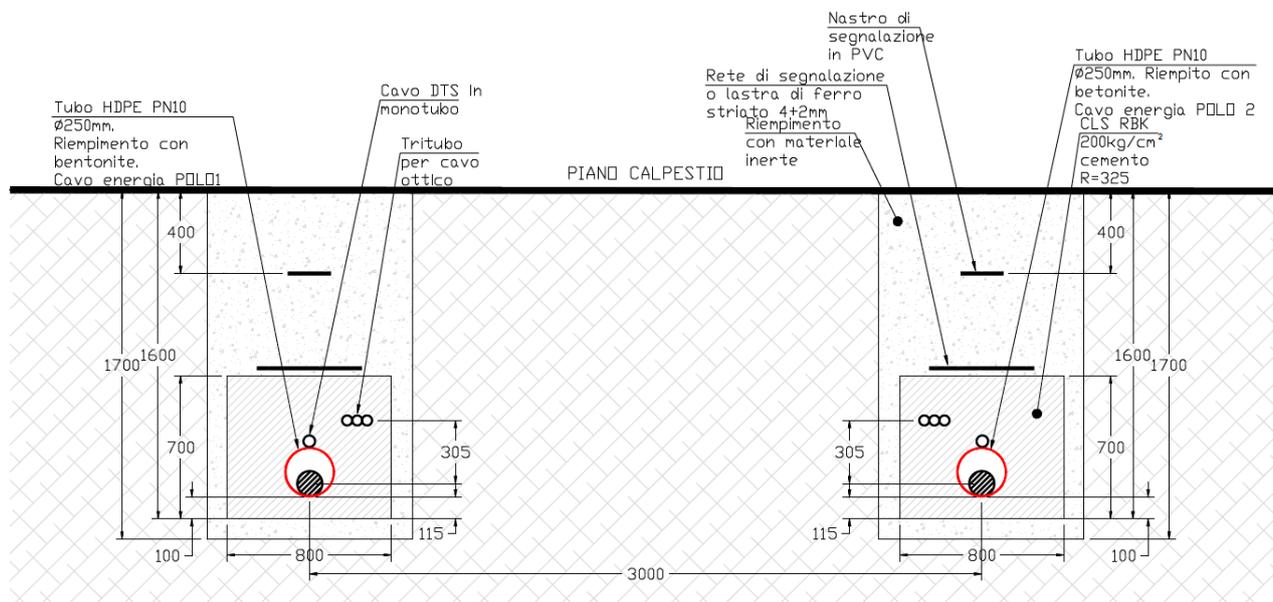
schema della sezione di posa dei cavi e delle apposite tubiere
